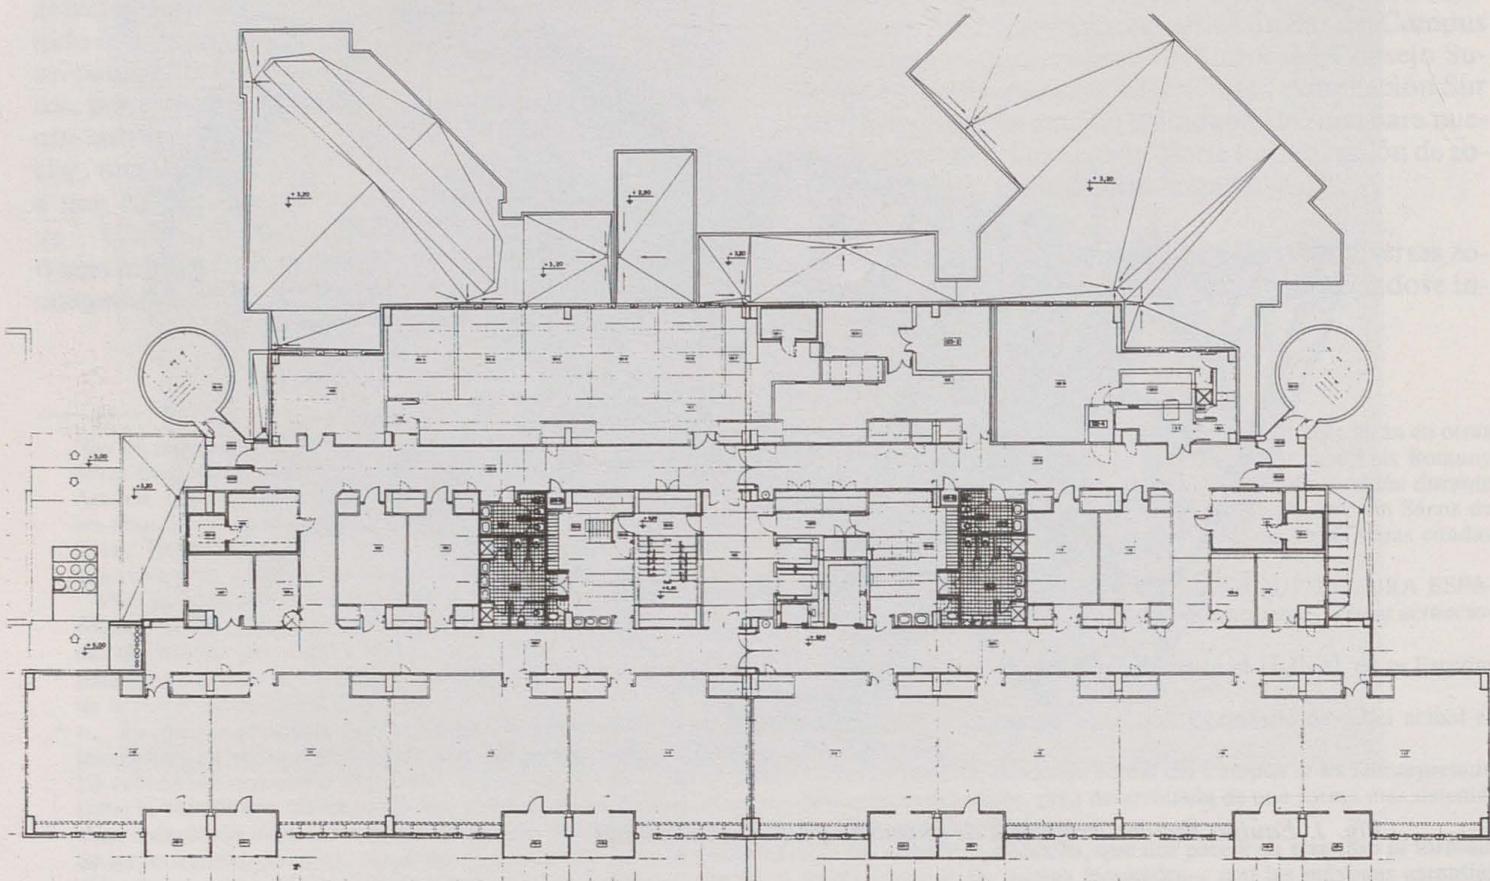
TERSSE & COLMENARES: Centro Nacional de Ingeniería Genética y Biotecnología. Planta tipo. Escala 1/200.
